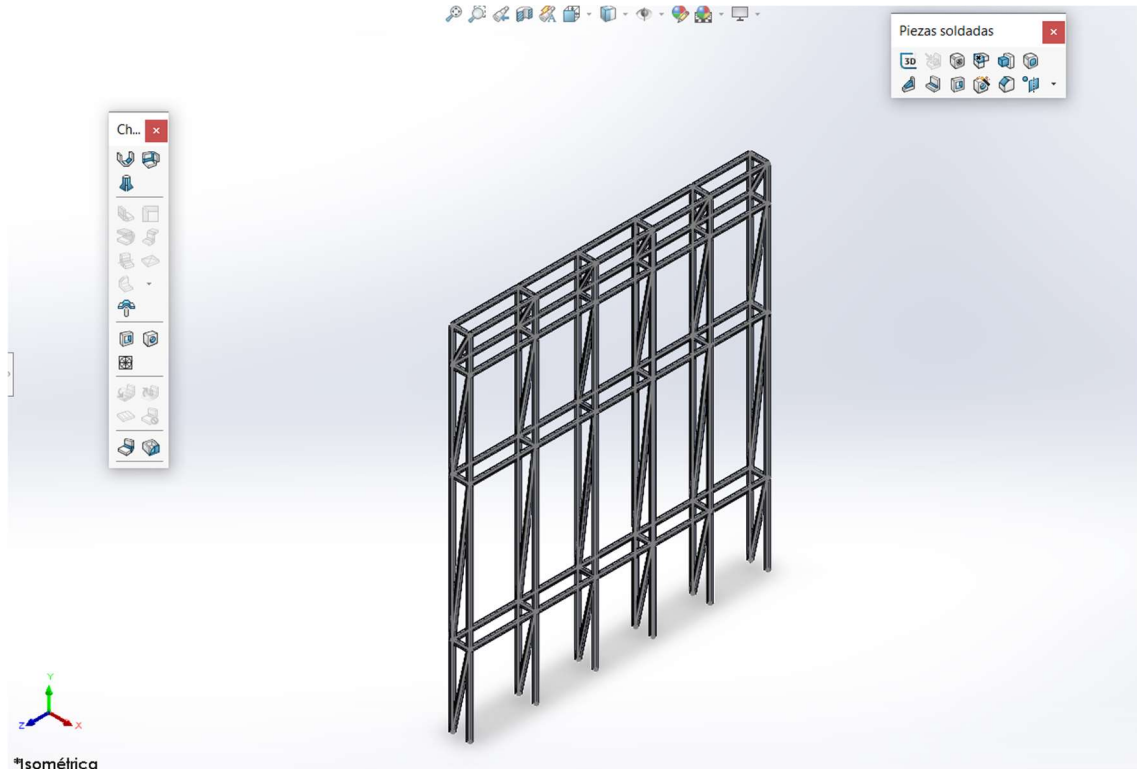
, Modelizado de la estructura de la fachada izquierda ( SOLIDWORKS)
